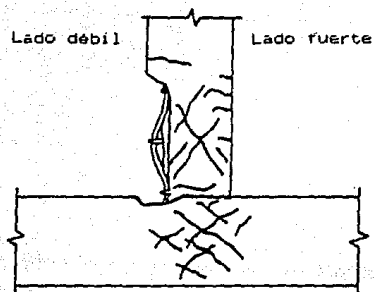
Pandeo del refuerzo longitudinal en la viga.
